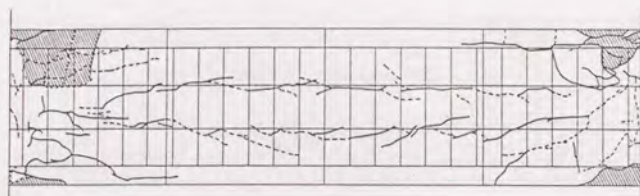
ひび割れ状況 (試験体 B1)
